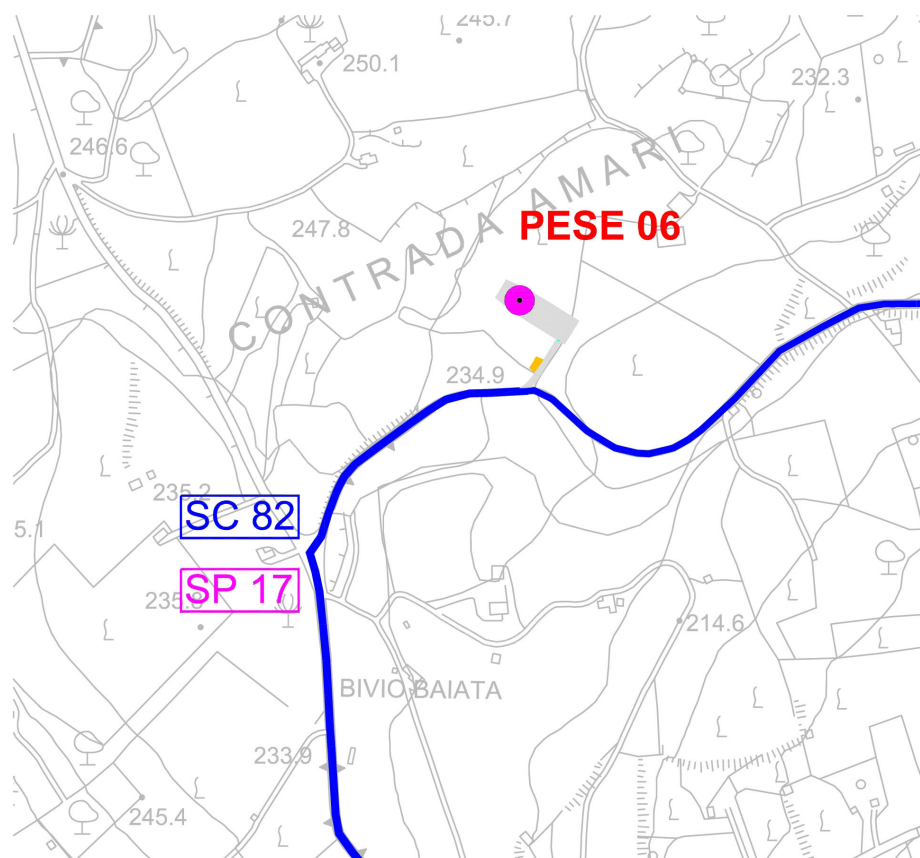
Planimetria delle strade di cantiere scala 1:5.000
